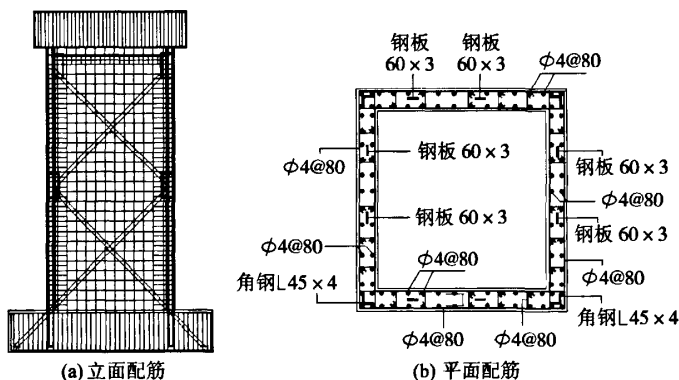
内藏钢桁架混凝土组合核心筒CW-2配筋图
